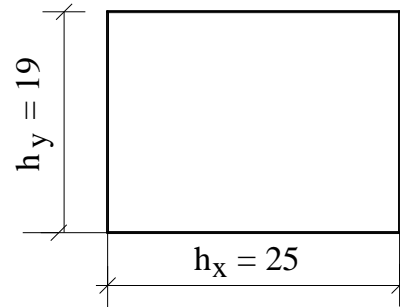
Dimensões (cm) da seção transversal do pilar P1.
